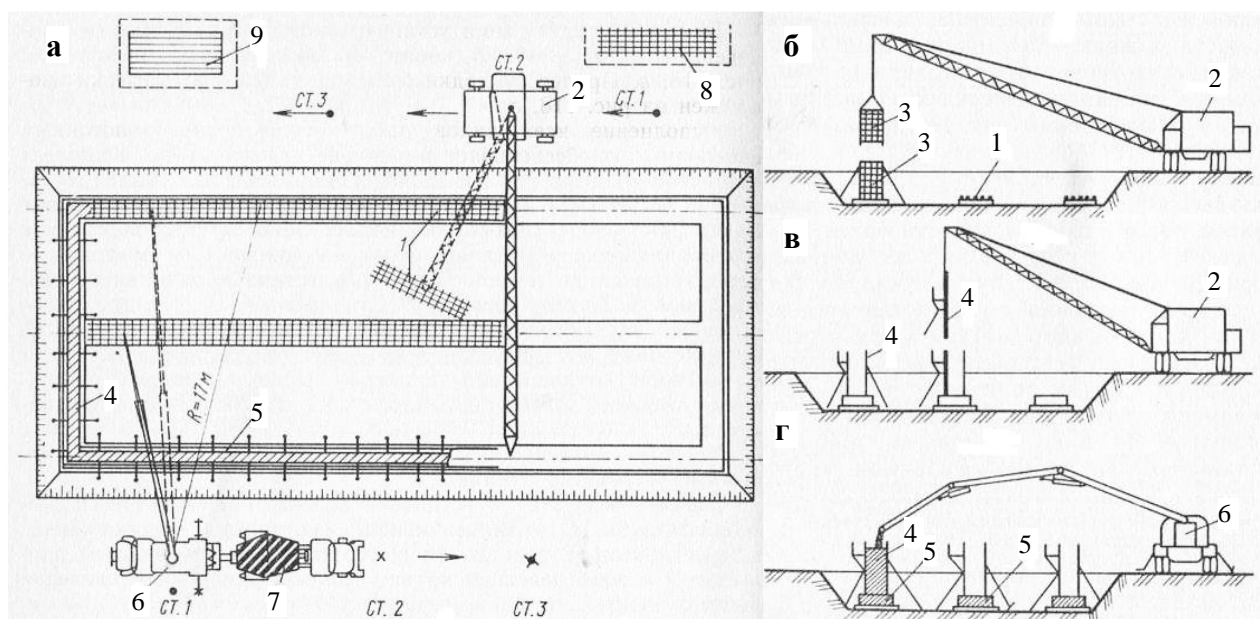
Схеми бетонування стрічкових фундаментів: а – план будівельного майданчика зі схемами руху крана й автобетононасоса; б – монтаж арматурних блоків; в – палублення; г – бетонування стрічкового фундаменту; 1 – сітки арматурні східчастої частини; 2 – кран пневмоколісний; 3 – каркас арматурний; 4 – щит опалубки; 5 – східчаста частина фундаменту; 6 – автобетононасос; 7 – автобетонозмішувач; 8 – майданчик складування арматурних виробів; 9 – майданчик укрупнювального збирання щитів, чищення й змазування опалубки; СТ – положення стоянки стрілового крана й автобетононасоса
